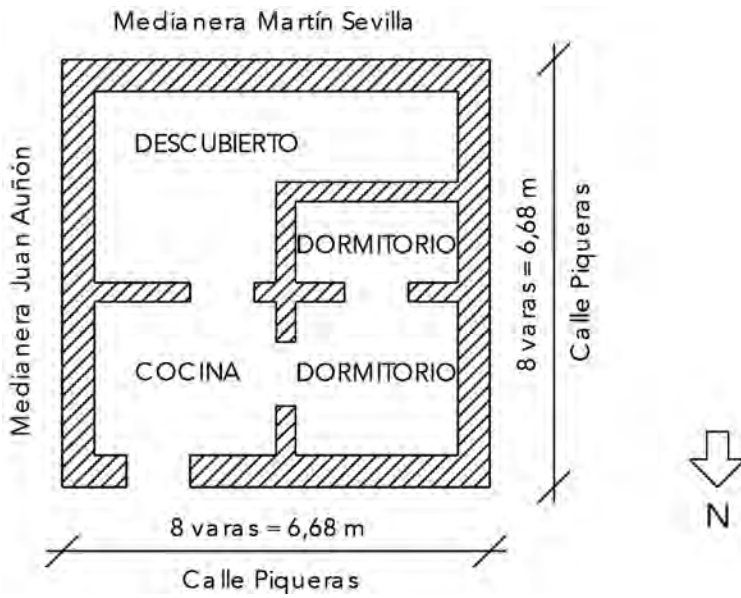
Planta de vivienda de Juan Galiano, Lezuza 1751.
